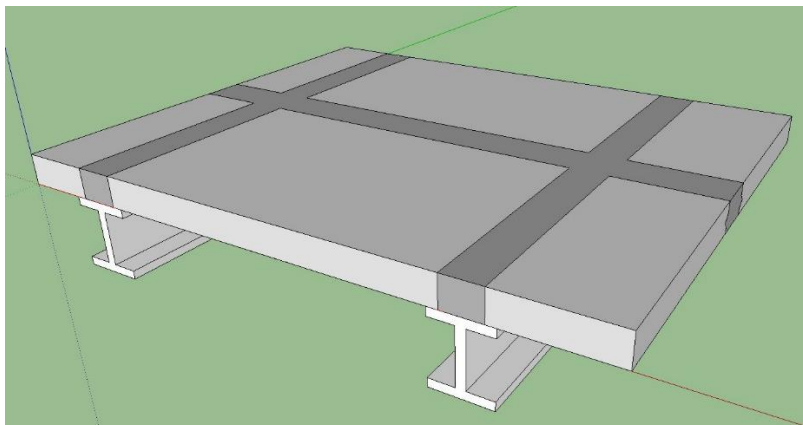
Système de dalles préfabriquées avec joint longitudinal et transversal
